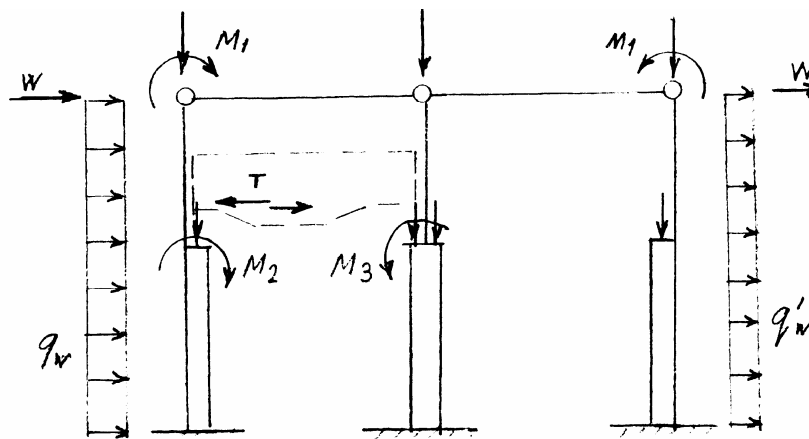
Розрахункова схема двопрольотної промислової будівлі із залізобетонним каркасом
